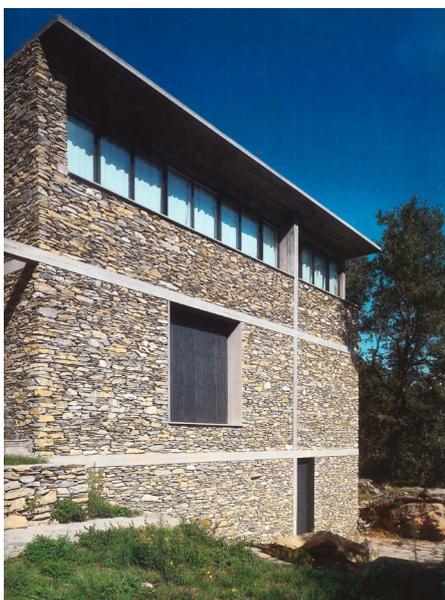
(esq.) Fachada sul. O vão horizontal moderno é enfatizado pela alvenaria horizontal de pedra xistenta e a pala de betão da cobertura
